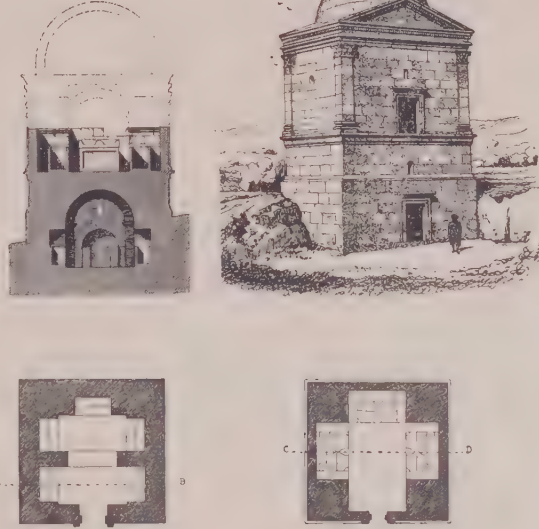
Christliches Mausoleum in Hass: Grundriß
